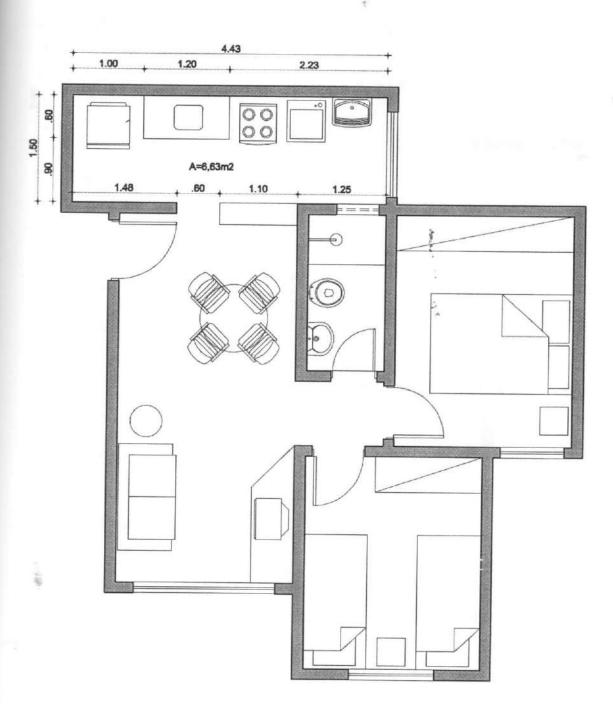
UH do Empreendimento B \underline{antes} da aplicação das diretrizes propostas. (Fonte: adaptado de SAMPAIO, 2010)
